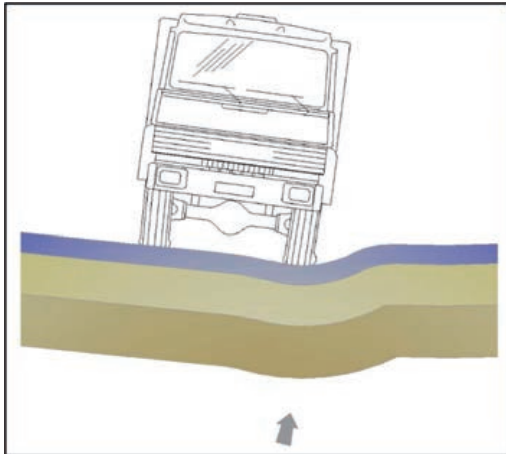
Y 258. DISTINTAS ETAPAS EN EL PROCESO DE FORMACIÓN DE LAS GRIETAS DE «PIEL DE COCODRILO».
